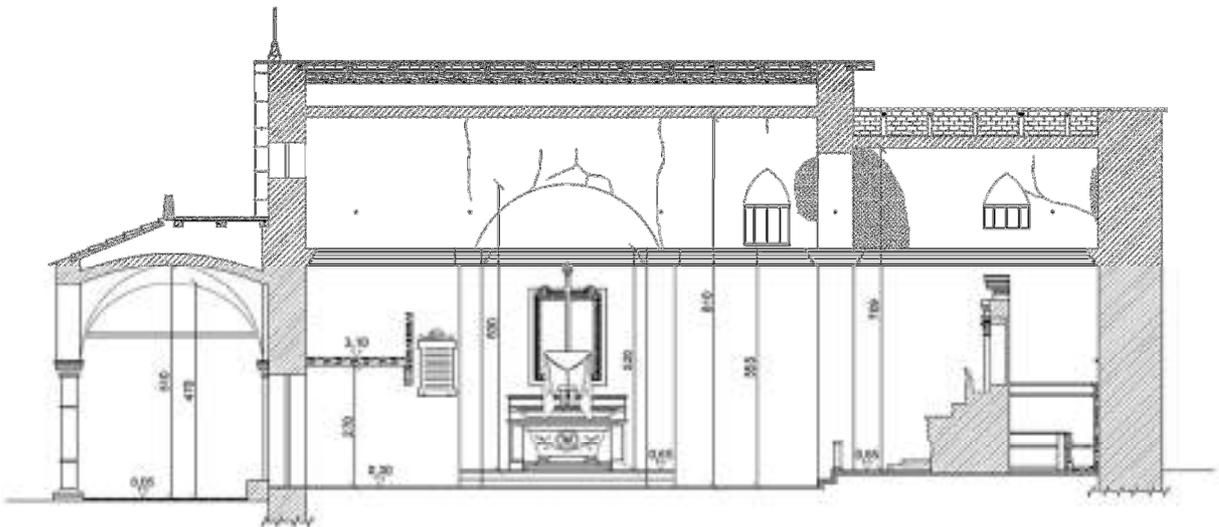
Sezione longitudinale D-D (Fonte: Tavola 3E)
